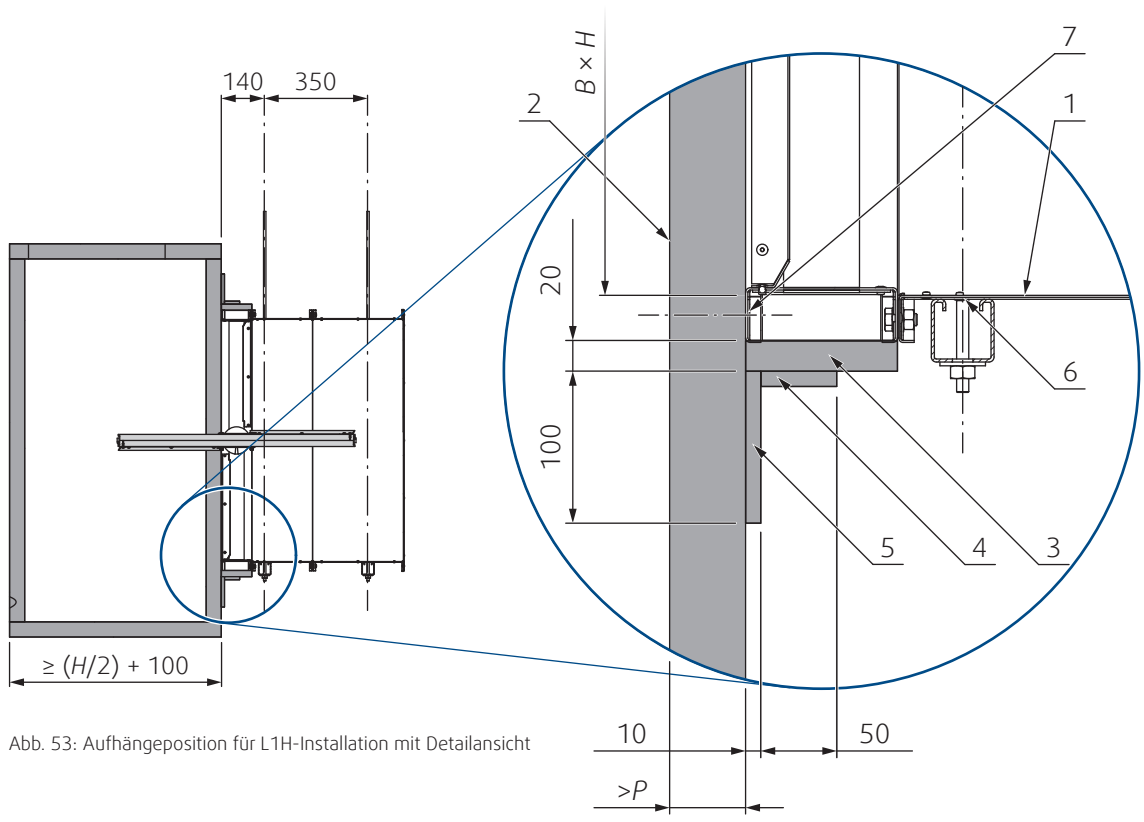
Aufhängeposition für L1H-Installation mit Detailansicht
